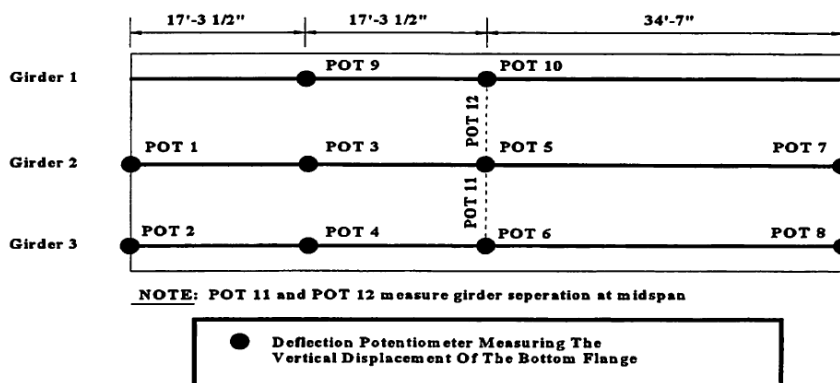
Planta de instrumentação da ponte: imagem retirada do relatório original.
